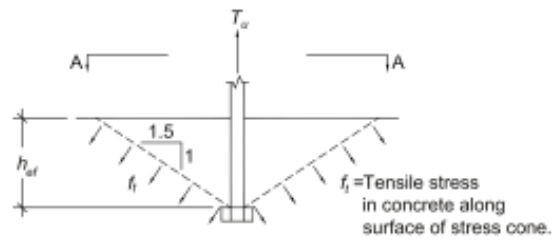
Cono de quebrantamiento del hormigón para una barra.
